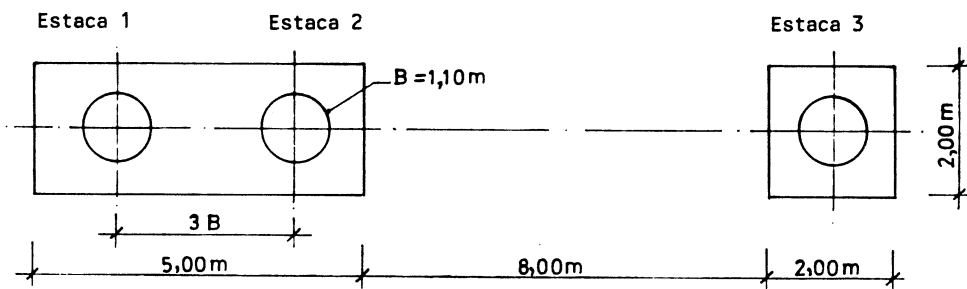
Ponte sobre o rio Arade - planta esquemática da disposição das estacas ensaiadas
